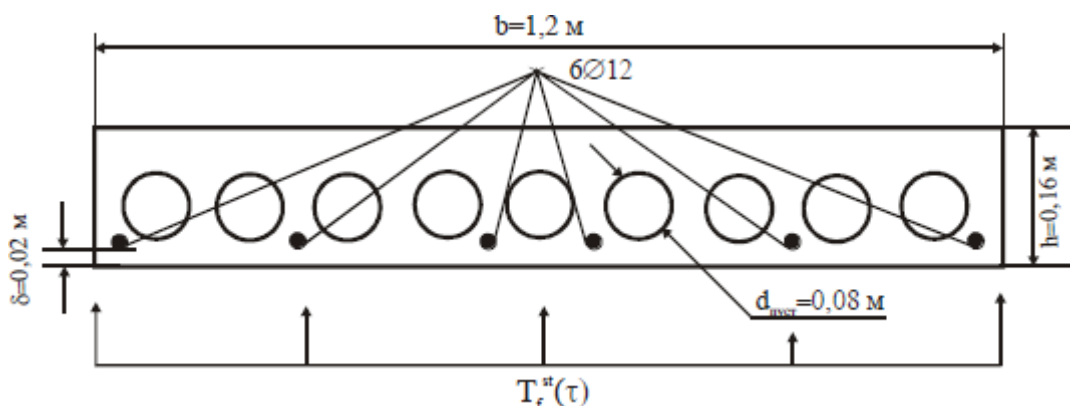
Поперечное сечение заданной многопустотной железобетонной плиты перекрытия и принятая схема воздействия пожара на плиту
